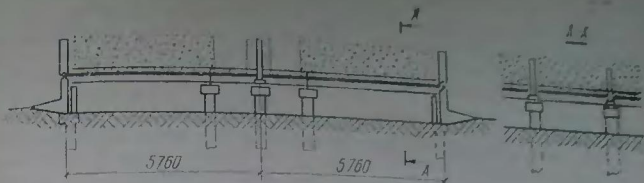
Схема безростверковых свайных фундаментов для крупнопанельных домов с измененной стеновой поперечной панелью
